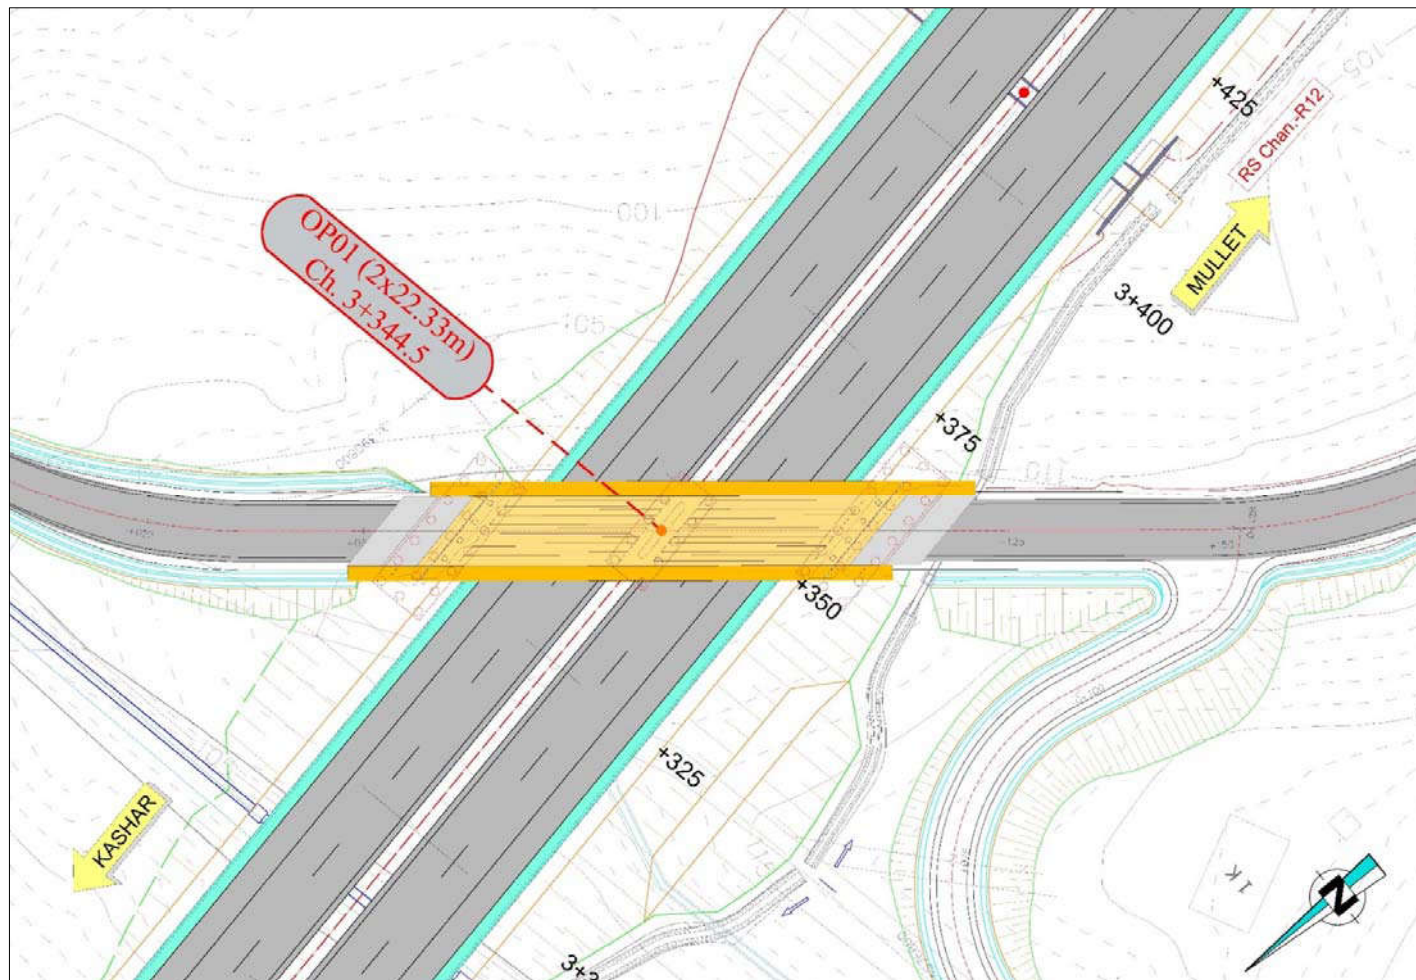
Pamje planimetrike e Mbikalimit 01, L=44.66m (Hapësira 2x22.33m)
